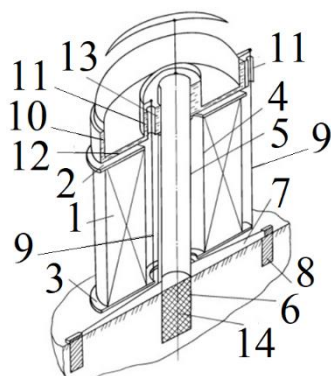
Сейсмостойкая конструкция здания: 1 – блок этажей; 2, 3 – плиты перекрытия; 4 – шахта; 5 – стойка; 6 – труба; 7 – лапы; 8 – сваи; 9 – тяги; 10 – ёмкость; 11 – каналы; 12 – чаша; 13 – жидкость; 14 – бетон
